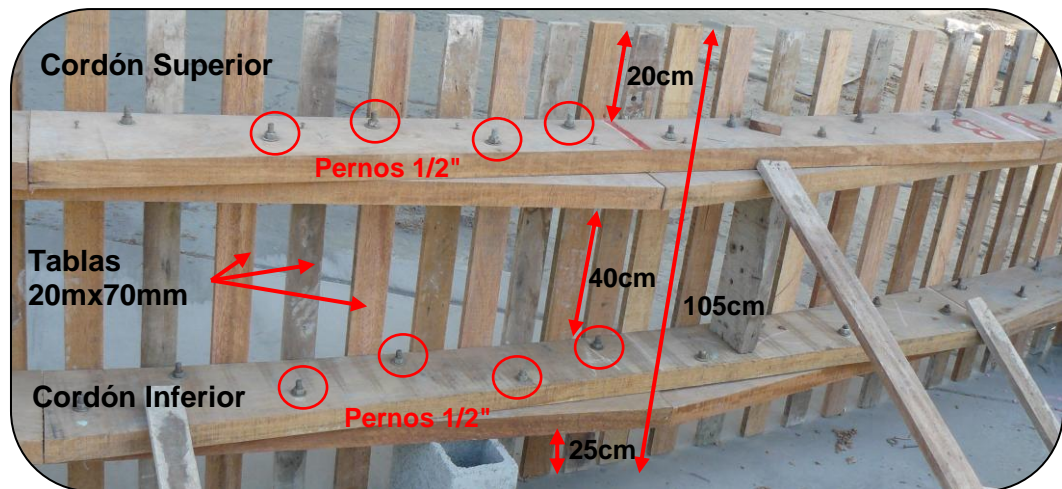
Distribución escalonada de los tabloneros para facilitar el montaje y desmontaje.
